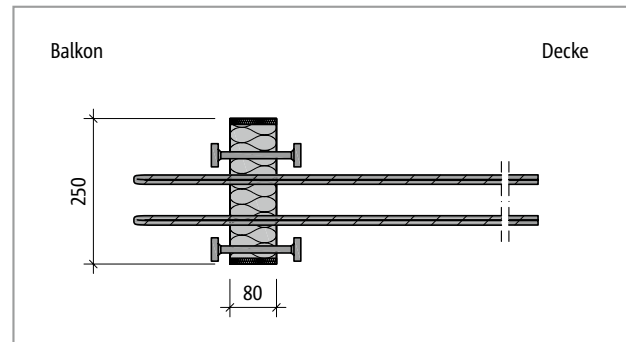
Schöck Isokorb® T Typ O bei REI120: Produktgrundriss; Brandschutzplatten seitlich
